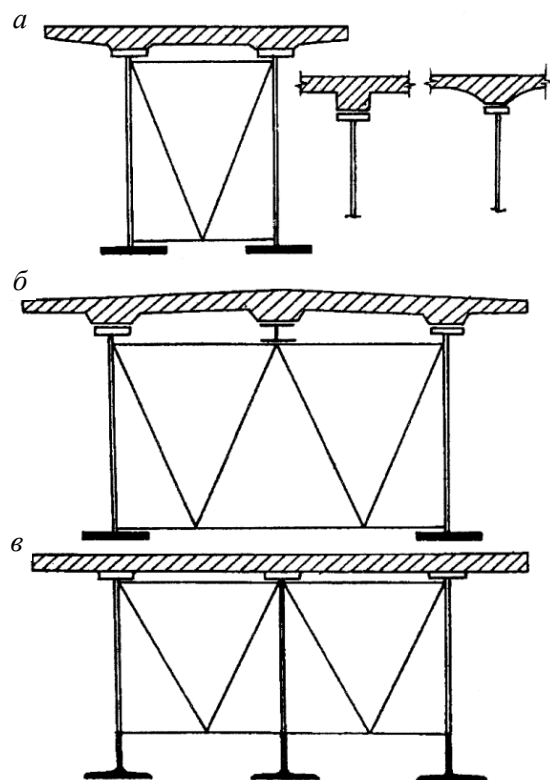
Основные схемы поперечных сечений бистальных и бисталежелезобетонных пролетных строений
